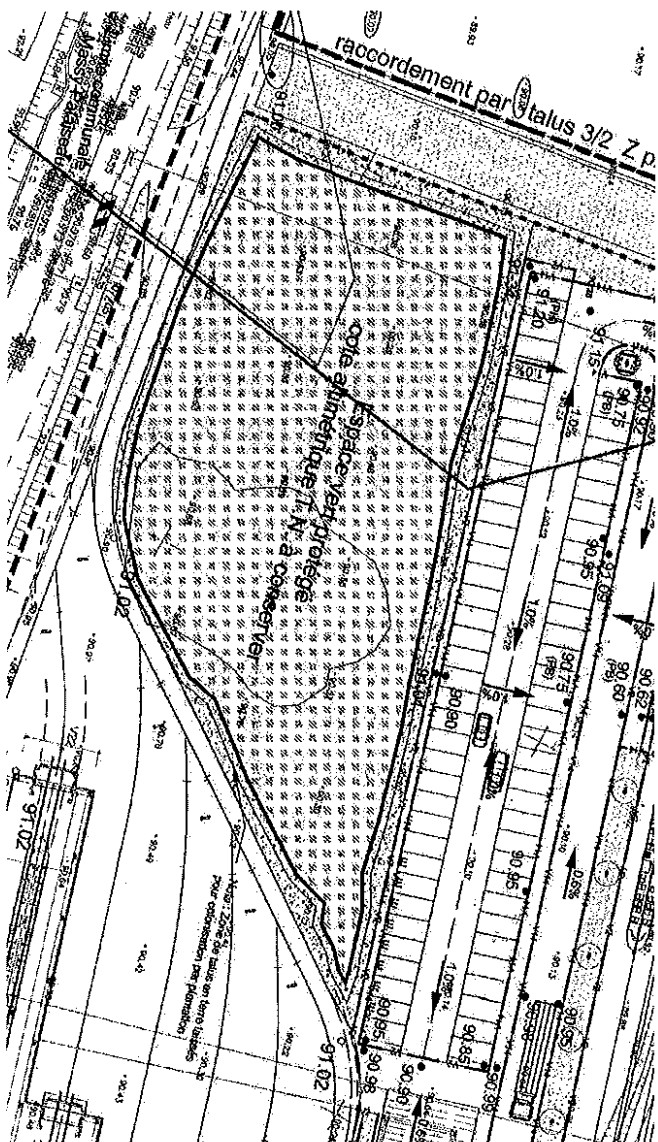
Plan des nivellements du site - Zoom sur la zone préservée (Source : ASEP, 2013)
